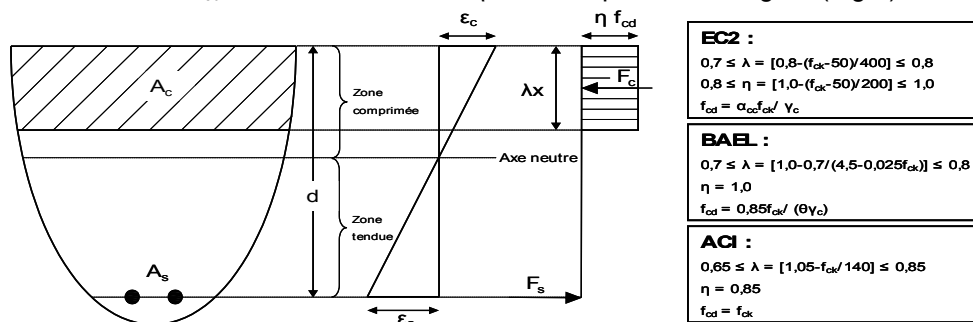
Section transversale d'une poutre en béton armé en flexion simple
